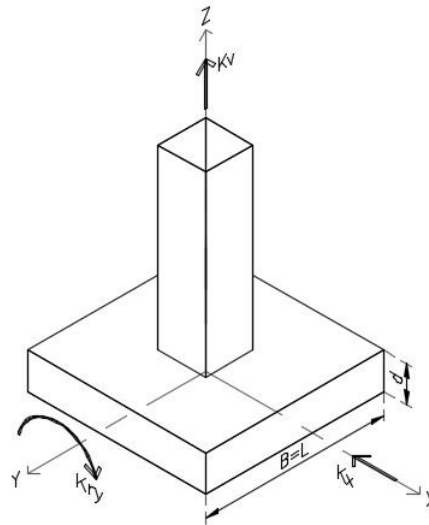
Restricciones en zapata bidimensional, en el plano XZ
